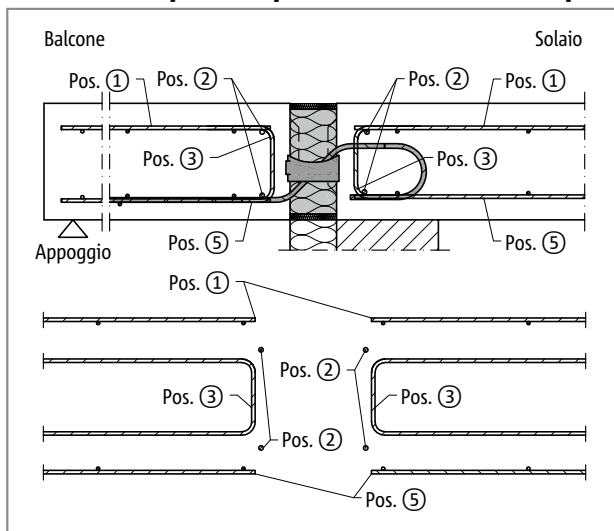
Schöck Isokorb® T tipo QP: armatura in opera
